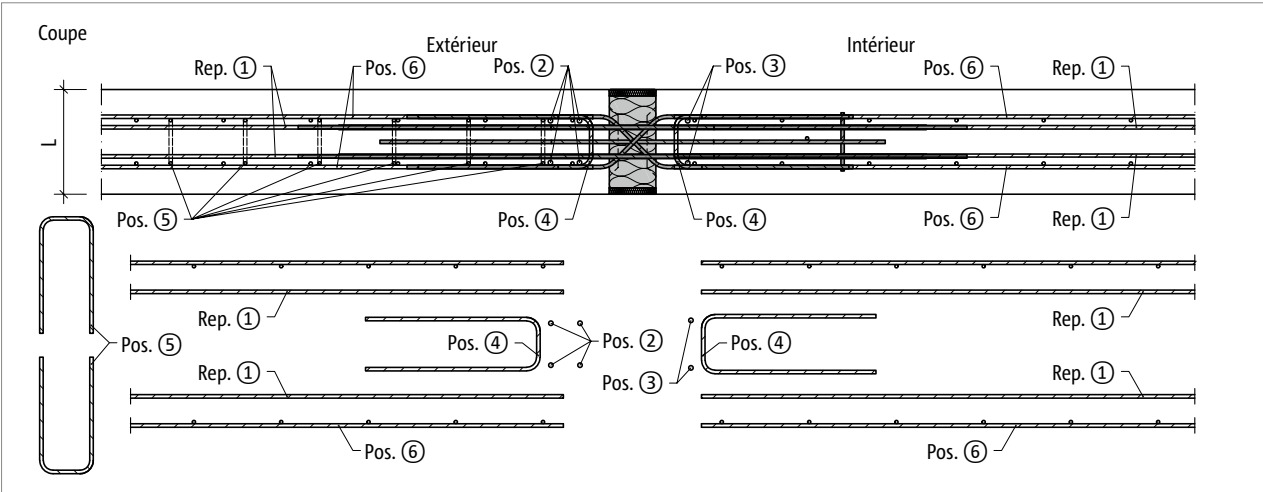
Schöck Isokorb® T type W : Renforcement sur site ; projection horizontale
